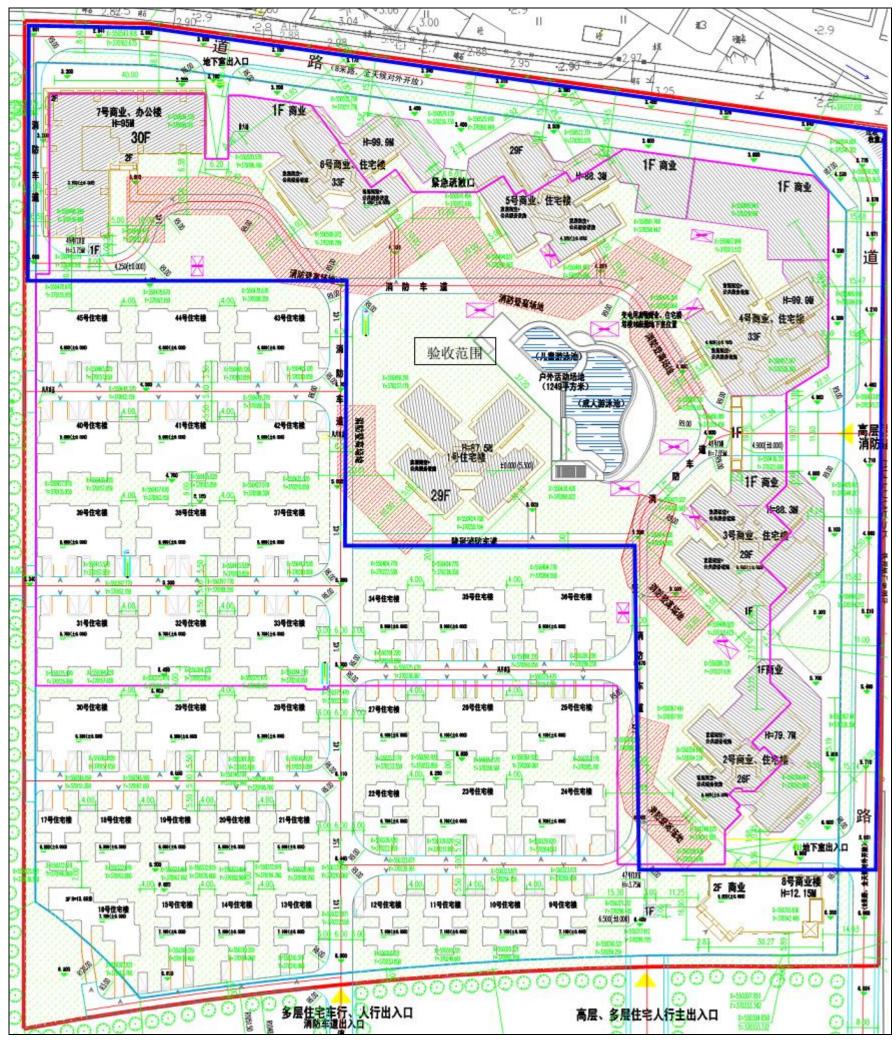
金地艺境水岸花园及本次验收内容平面布置图
